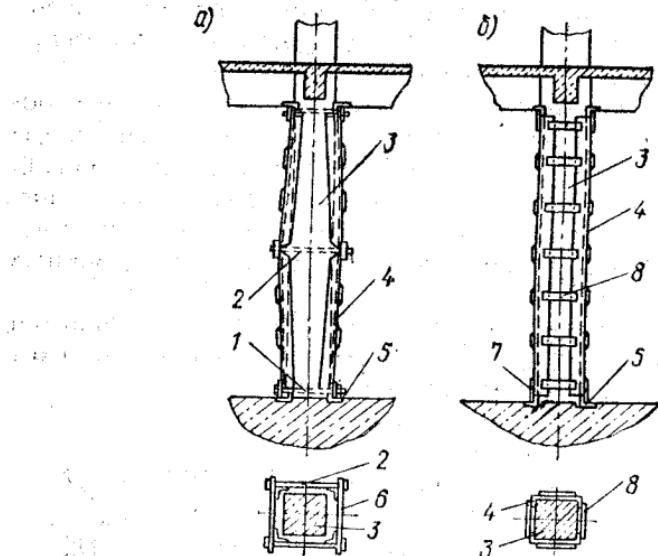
Усиление колонны предварительно напряженными двусторонними металлическими распорками:
